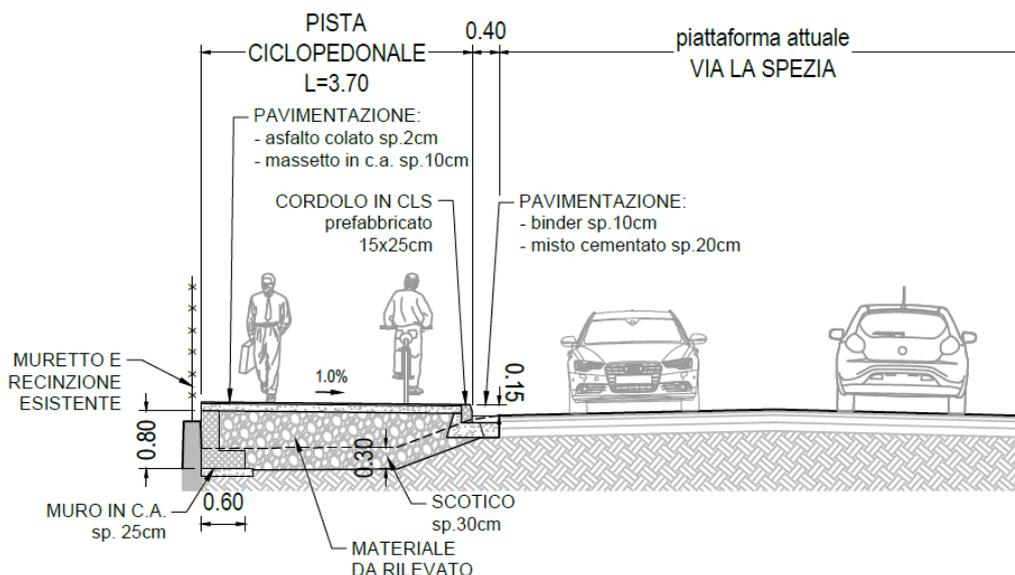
Sezione tipo pista ciclopedonale su marciapiede
